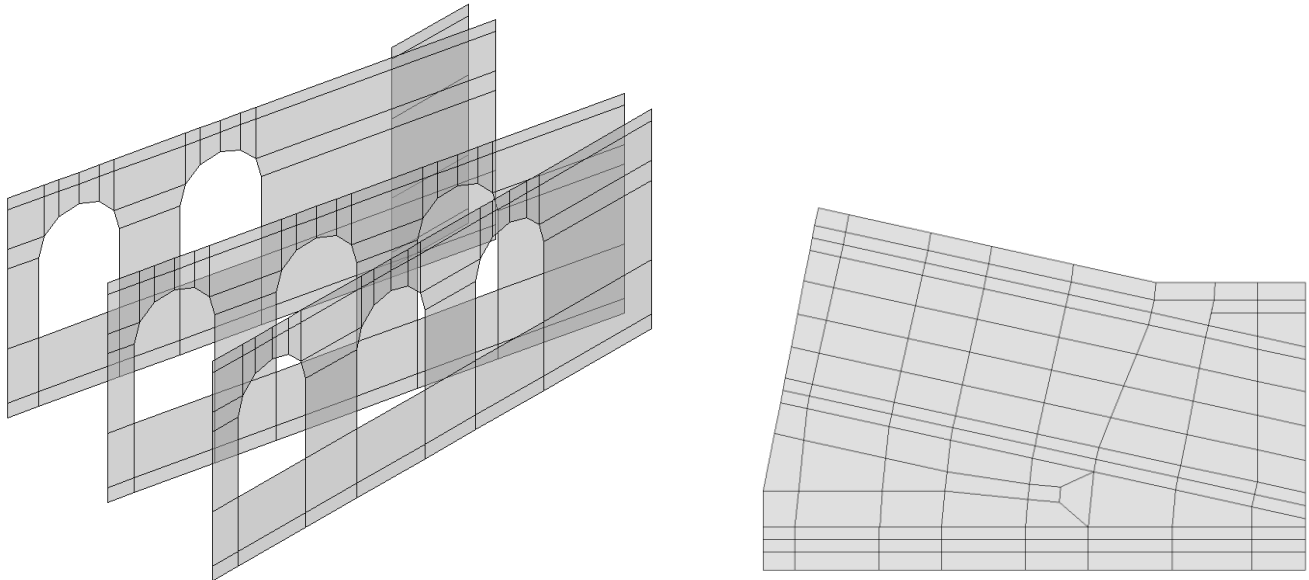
Prospetti pareti (sx), pianta fondazione (dx)
